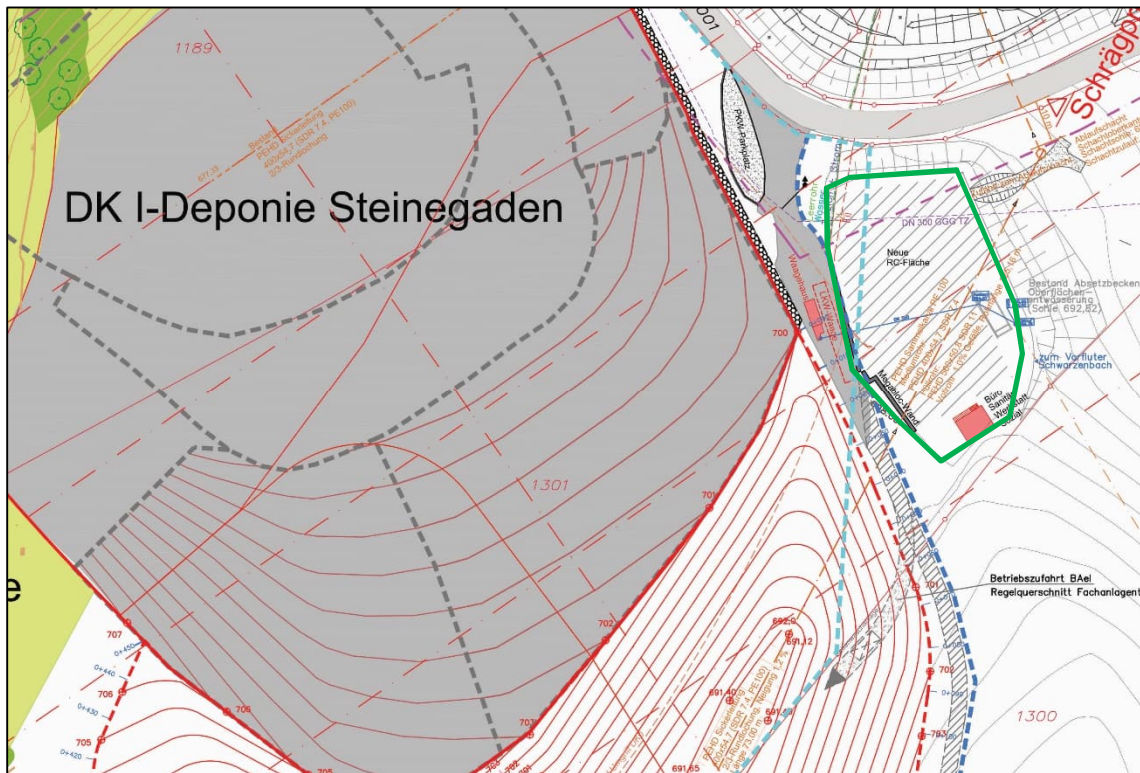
Geplanter Standort der Bauschutttaufbereitung inkl. Lagerflächen (grün)
